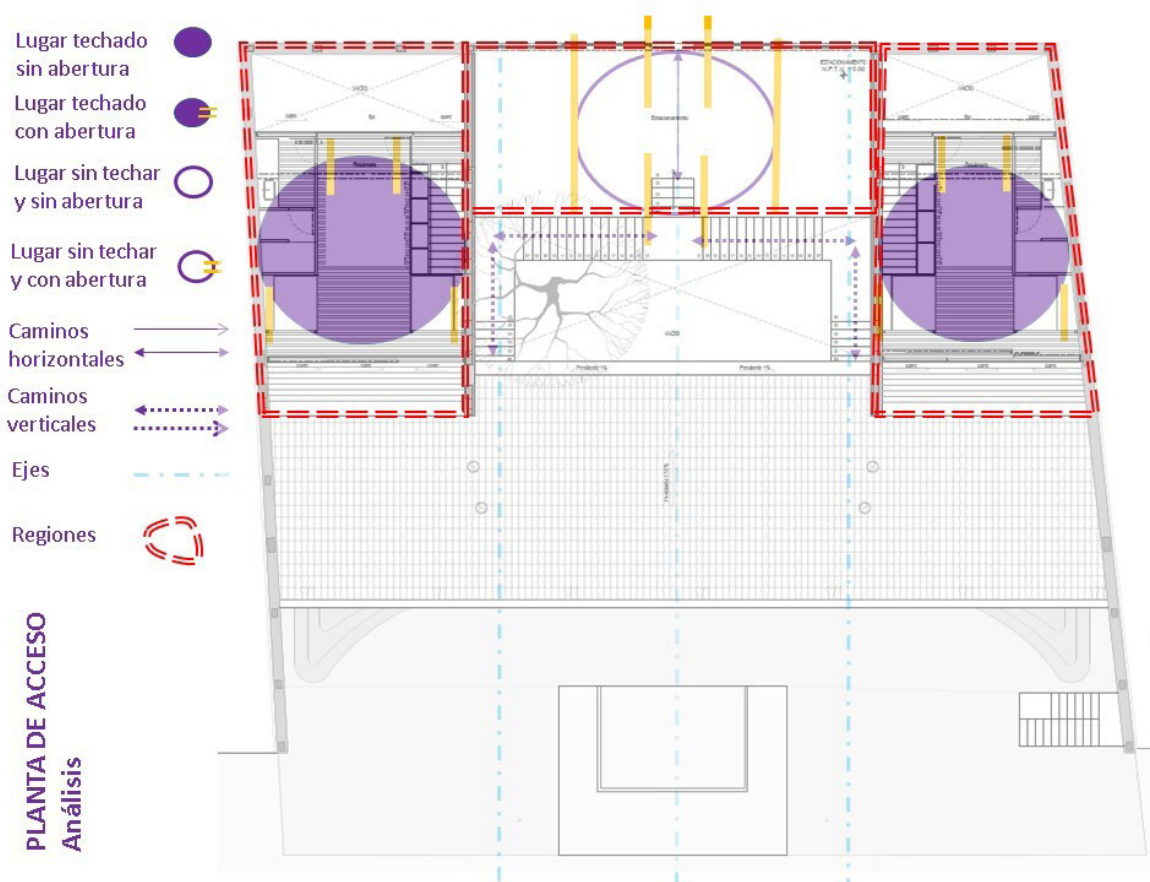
Análisis de planta de acceso. Plano base del archivo de Módica Ledezma. Reproducida con permiso de la autora Mondragón Ruiz (2023).
